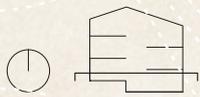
Grundriss: Zone II: EG, A 1:400
